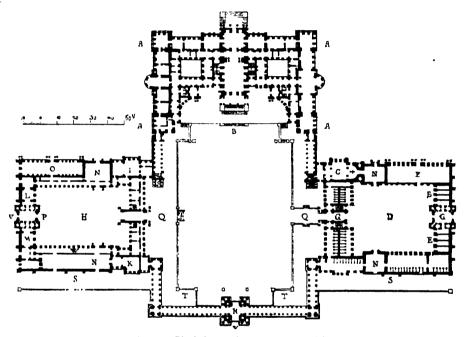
Blenheim castle, Oxford. Grundriss.
